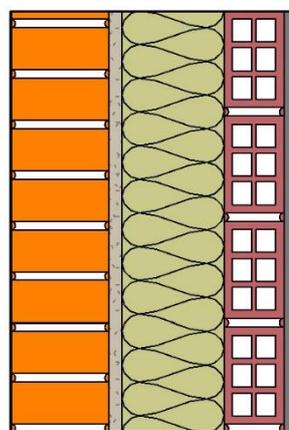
Detalle cerramiento exterior. Fuente: [2]
